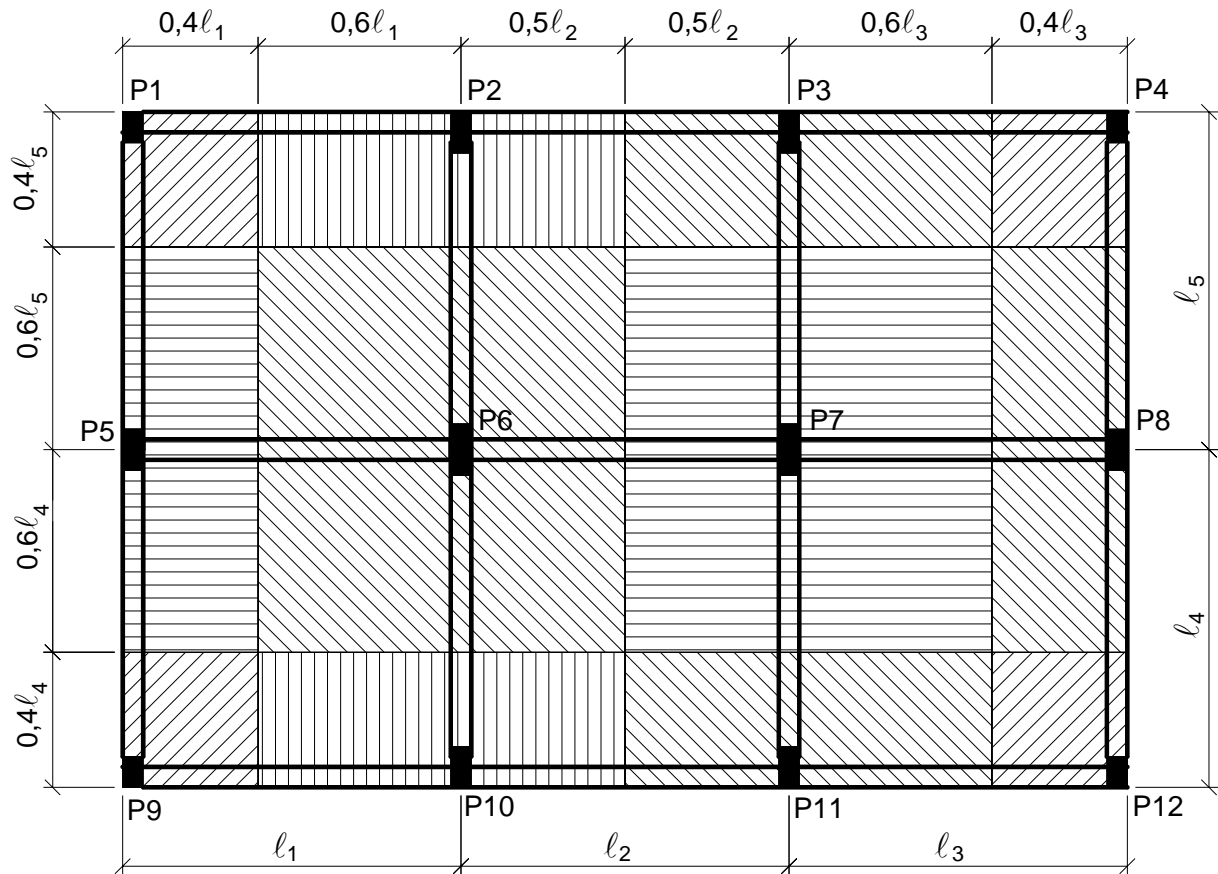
Processo simplificado para determinação da área de influência dos pilares.
